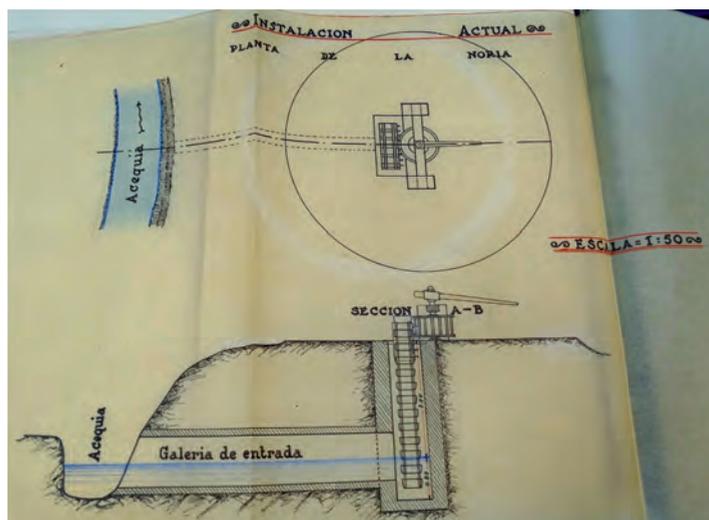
Plano de la noria instalada. Foto de los autores. ACHS.
